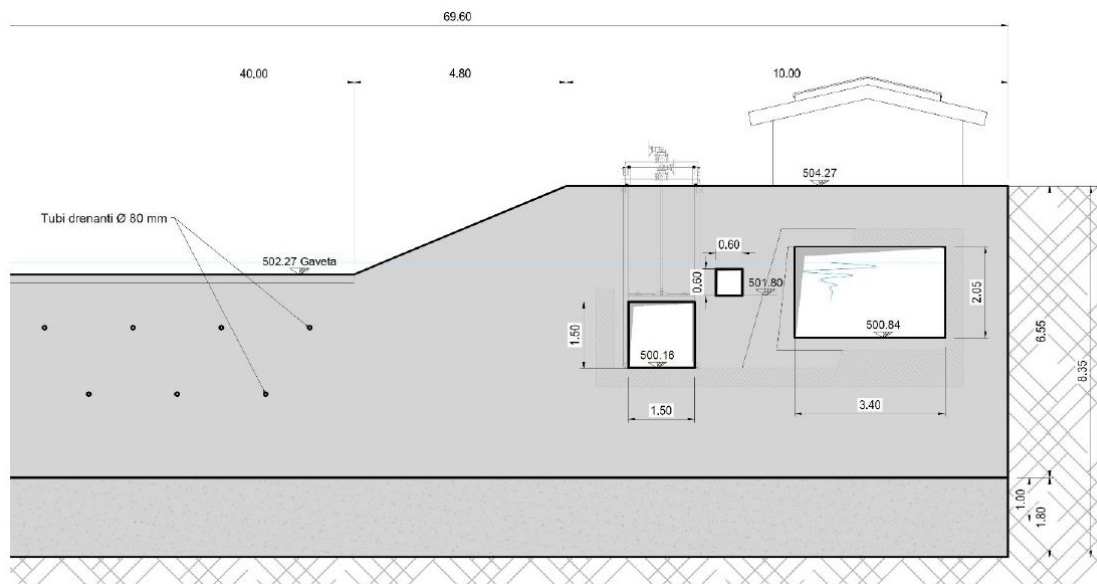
Particolare della sezione della briglia vista da monte, con le aperture di alimentazione dell'impianto e accennata l'opera di presa. Lunghezza di sfioro 40 m. Lunghezza totale 69.60 m
